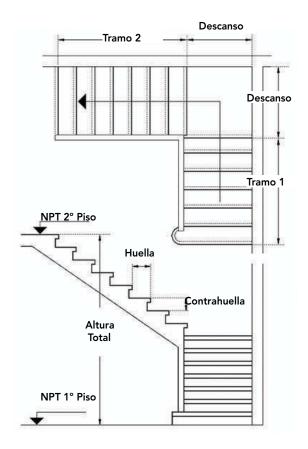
4: Planta y elevación tipo de una escalera de dos tramos en ángulo recto con descanso.
